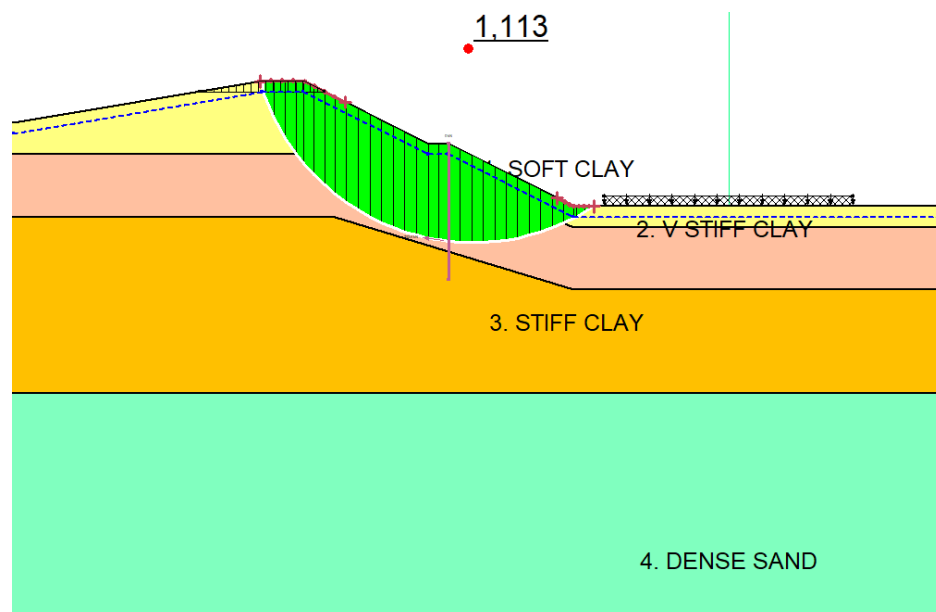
Nilai *Safety Factor* Statik Perkuatan *Secant Pile* Metode *Crack Soil* MAT -1,0 m
